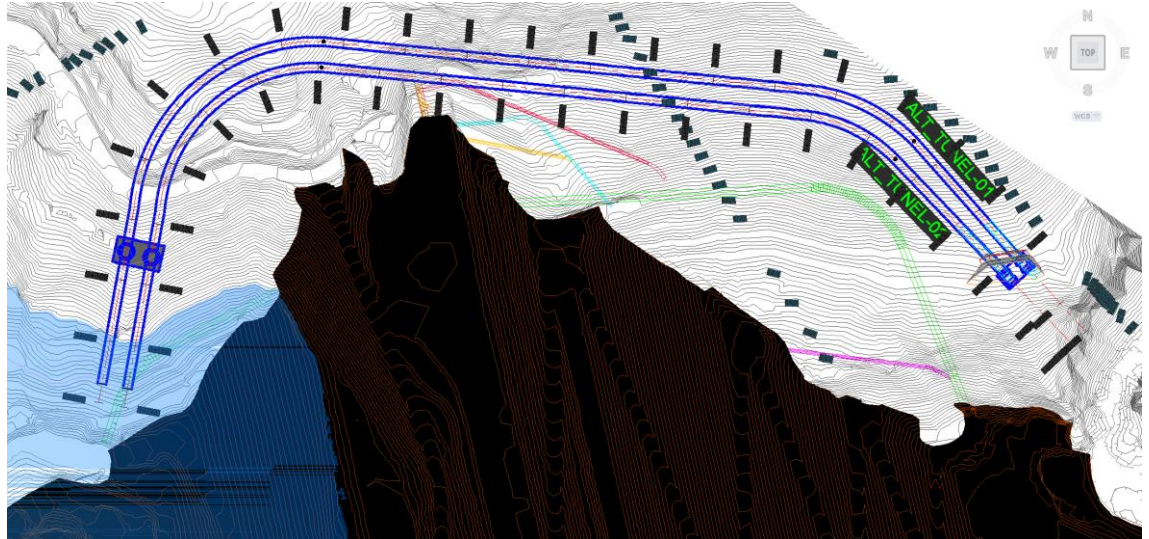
Posible arreglo de una descarga intermedia independiente – Vista planta
